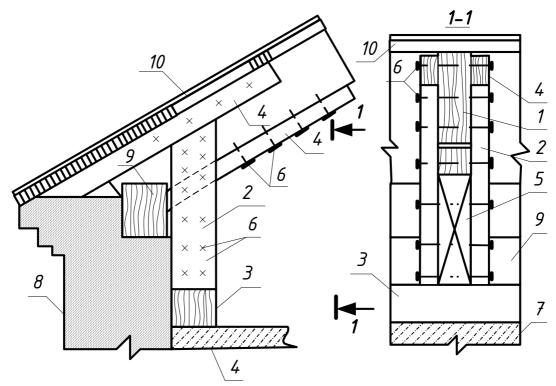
Установка стоек, опирающихся на перекрытие:
